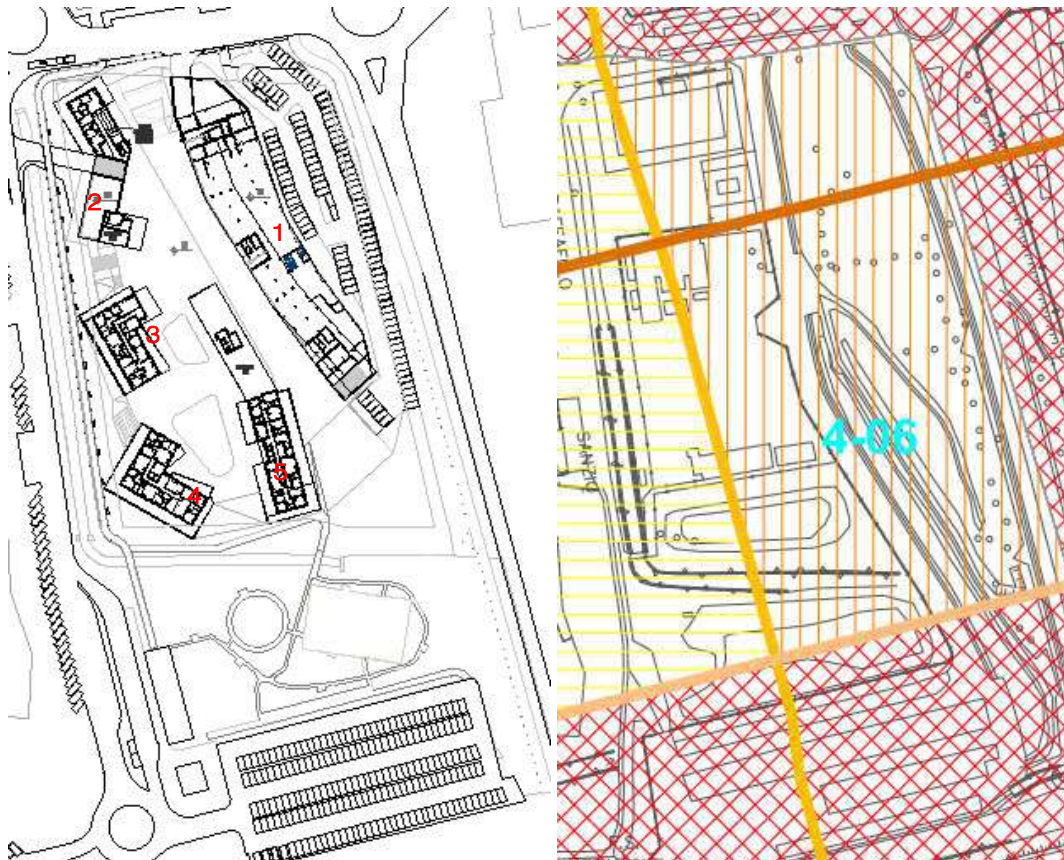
Planimetria con identificazione dei ricettori di progetto con le fasce di rispetto delle infrastrutture
